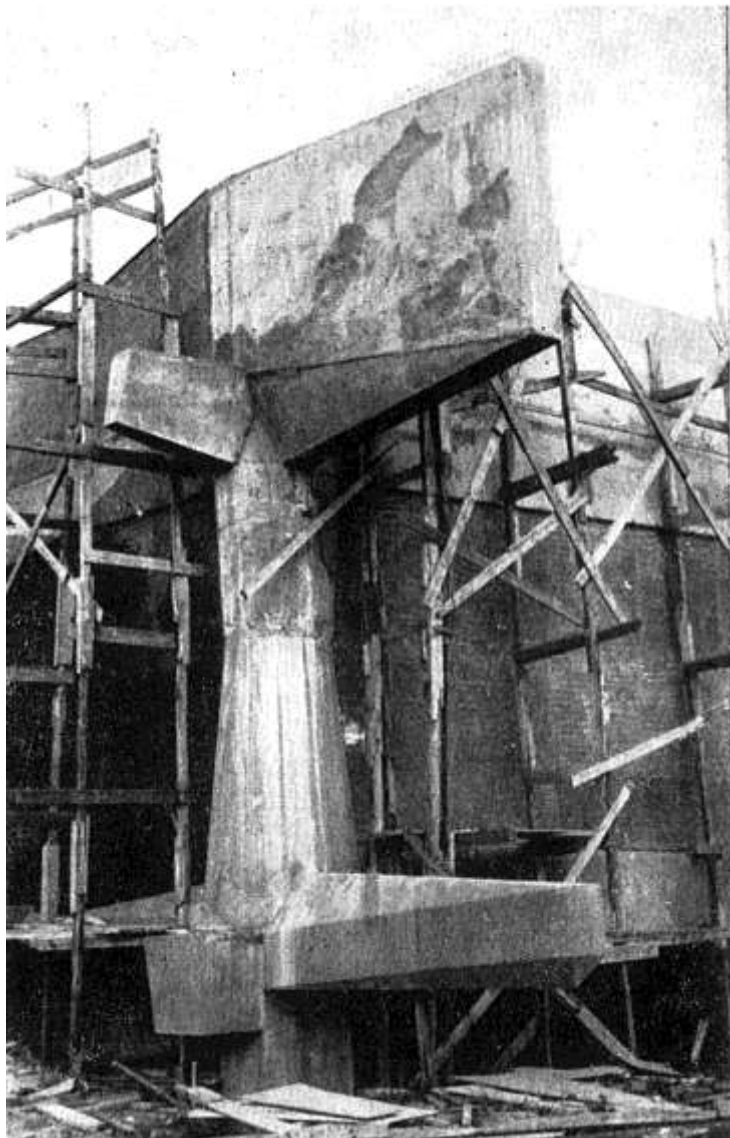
Fábrica y Manufacturas Sumar, Santiago de Chile. Fotografía detalle estructura en hormigón armado. En: Revista Técnica y Creación N°8. Instituto de Edificación Experimental Universidad de Chile, Santiago, 1965.
